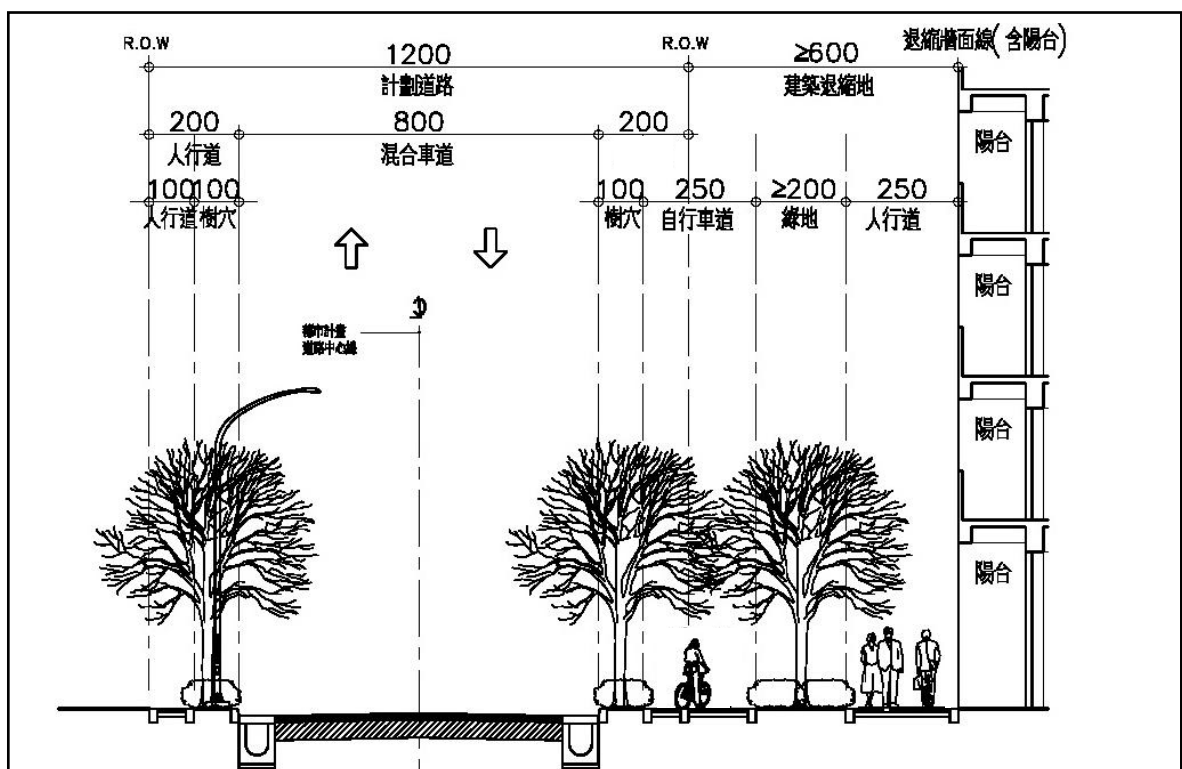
建築基地臨道路退縮空間配置示意圖（一）
